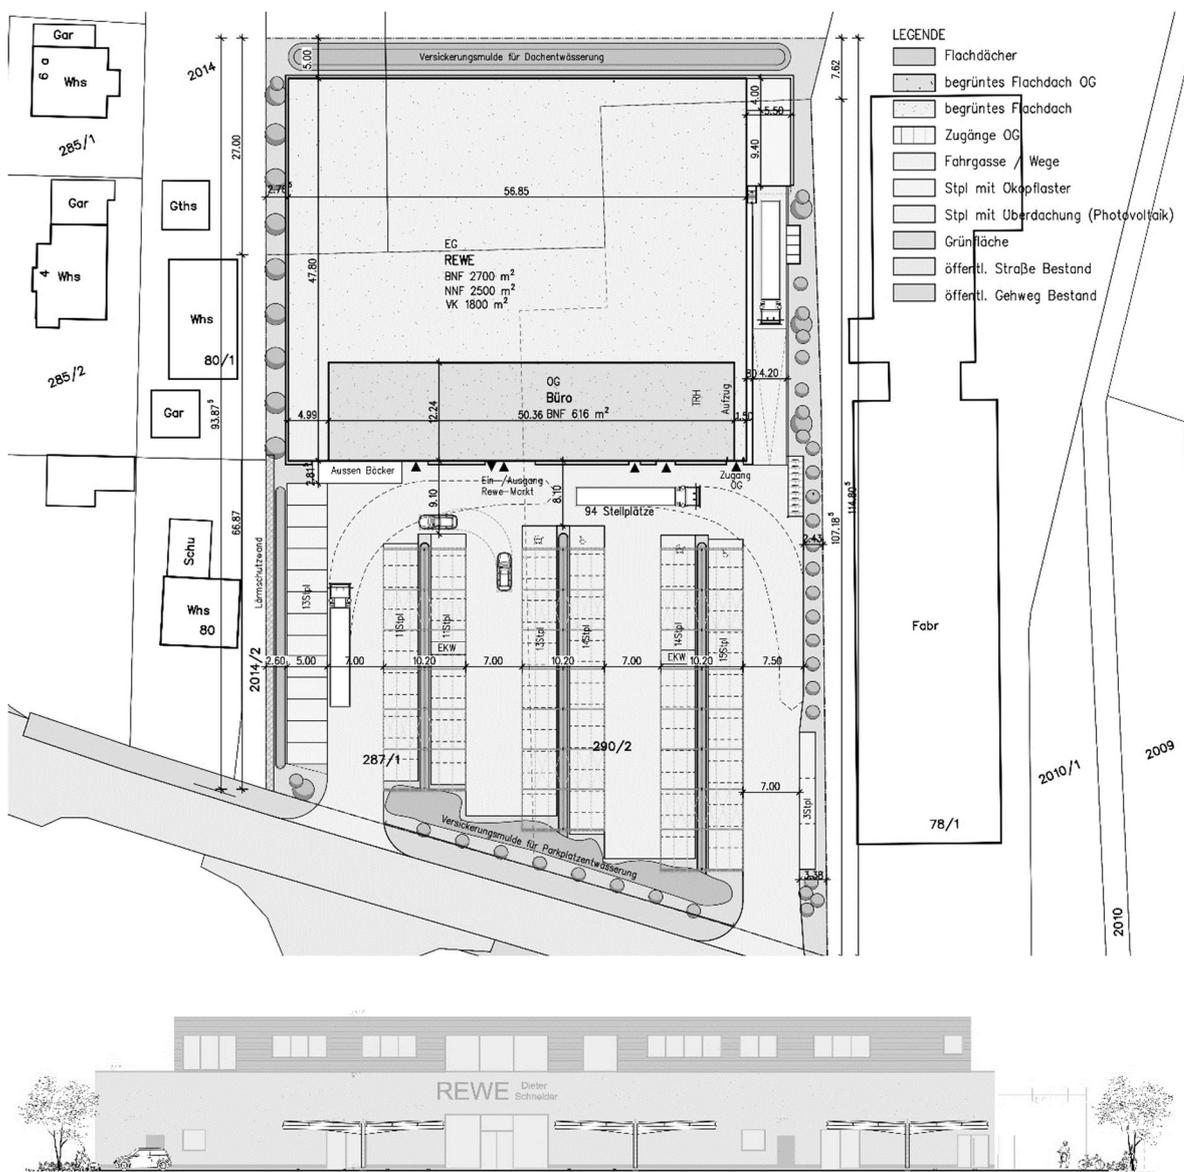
Lageplan und Südansicht des Lebensmittelmarktes (Quelle: INWO-Bau GmbH)
